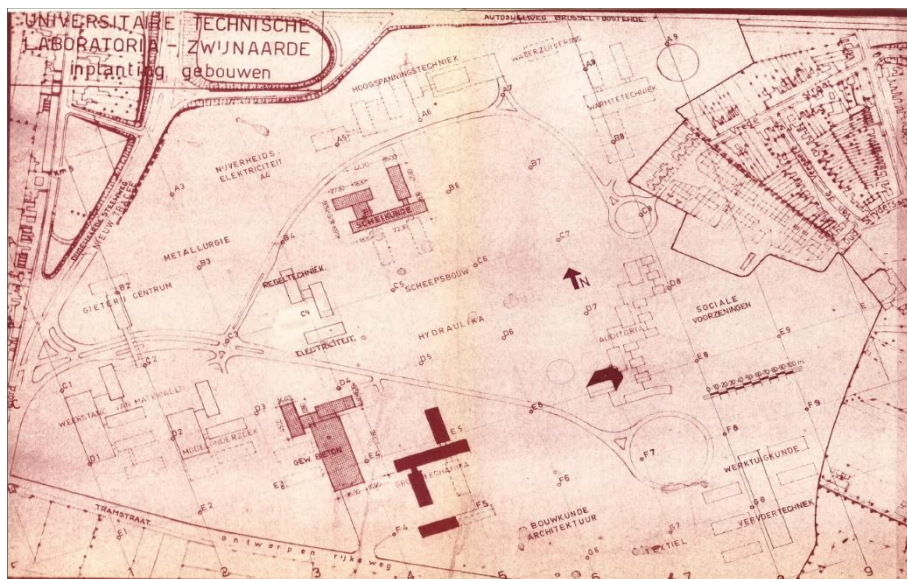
Inplantingsplan campus Ardoyen 1965 (bron : UGent)
